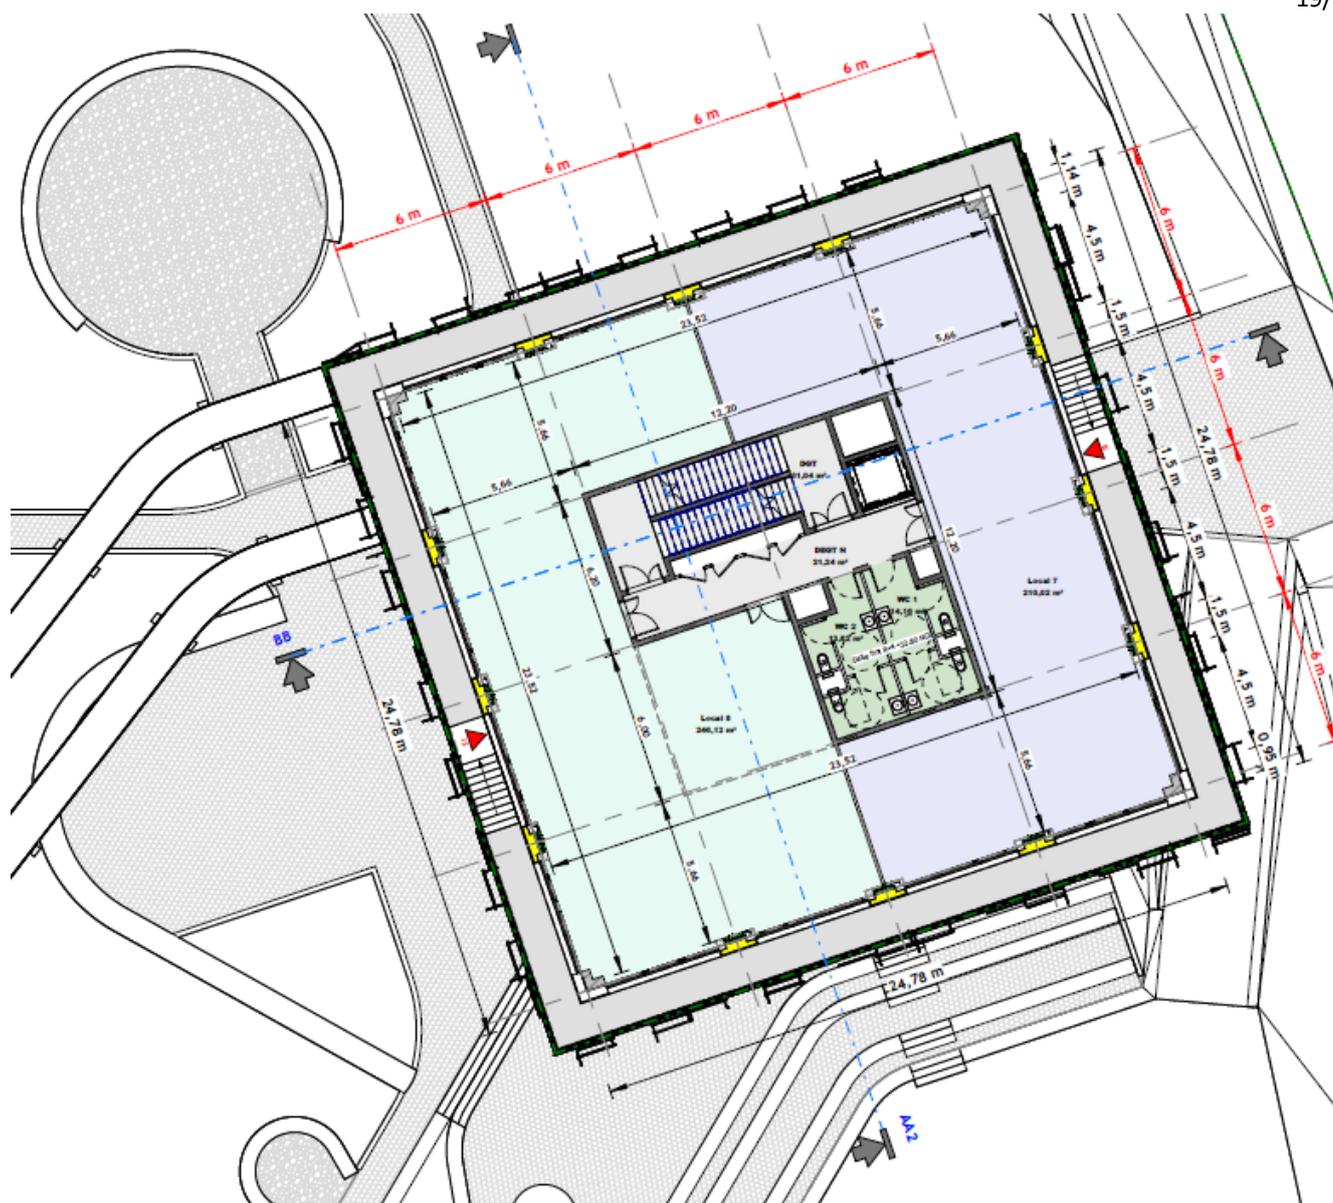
Plan de pavillon – niveau R+4 (février 2024)
